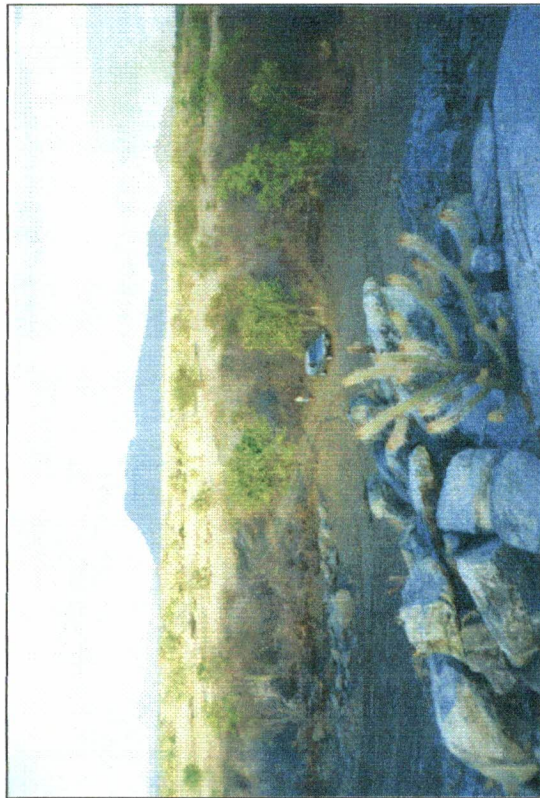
Acesso construído para atingir a pedreira.
